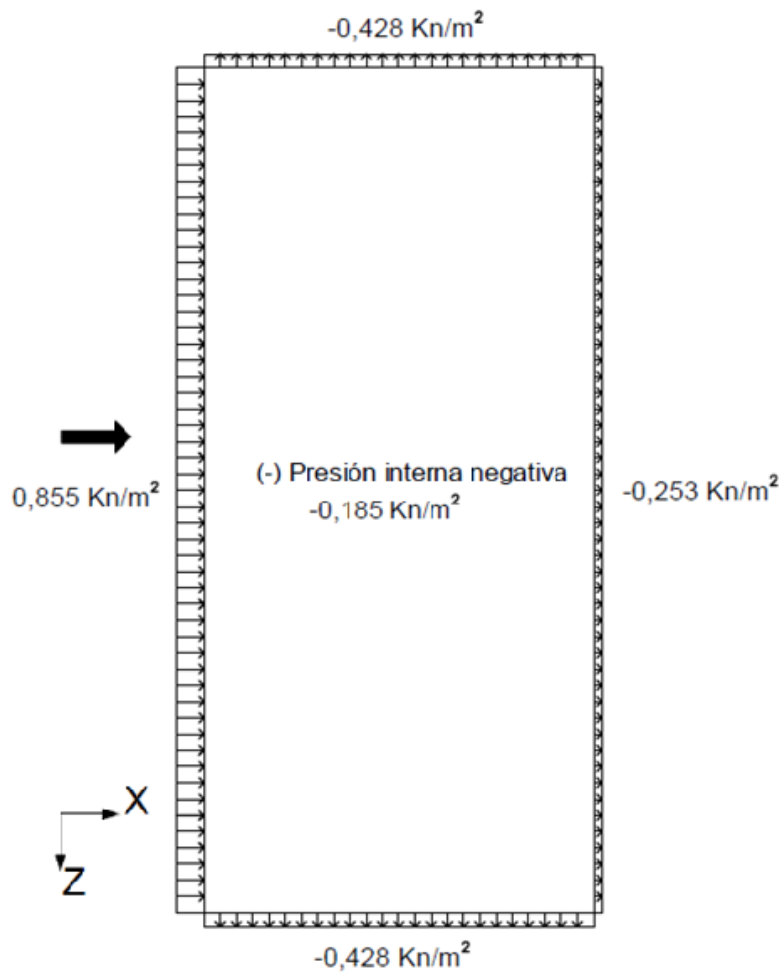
Vista en planta-Presiones de viento en la estructura
